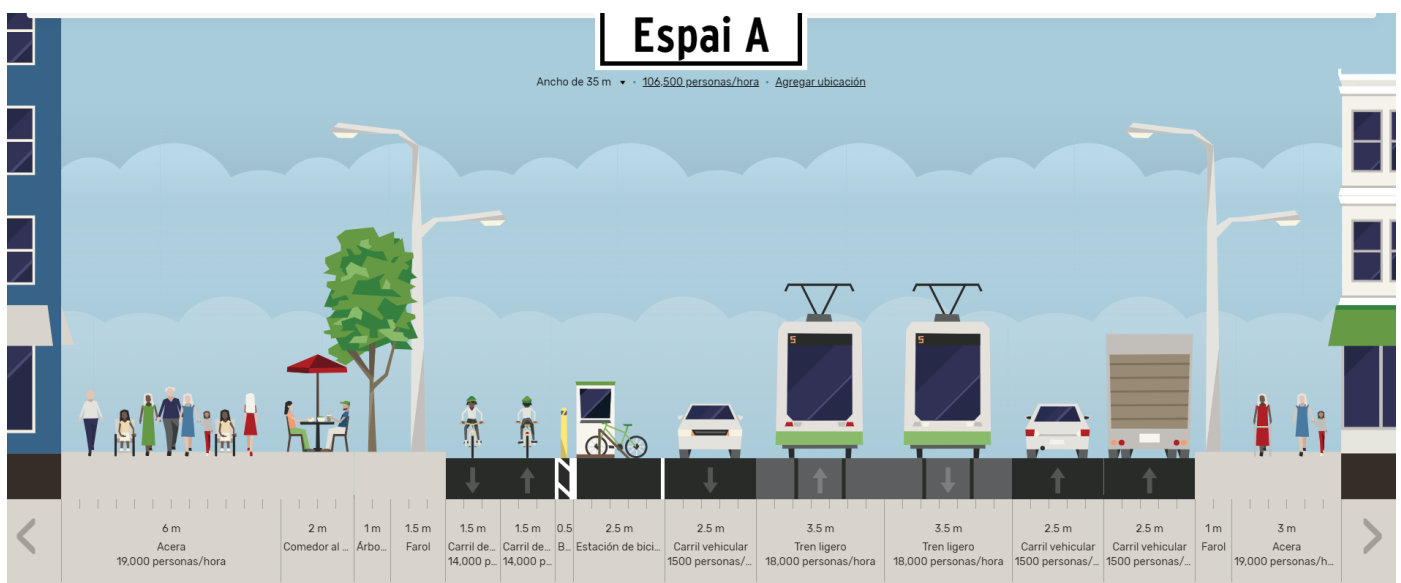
proposta de secció per a l'espai A [Font: aplicació streetmix.net i elaboració pròpia]
